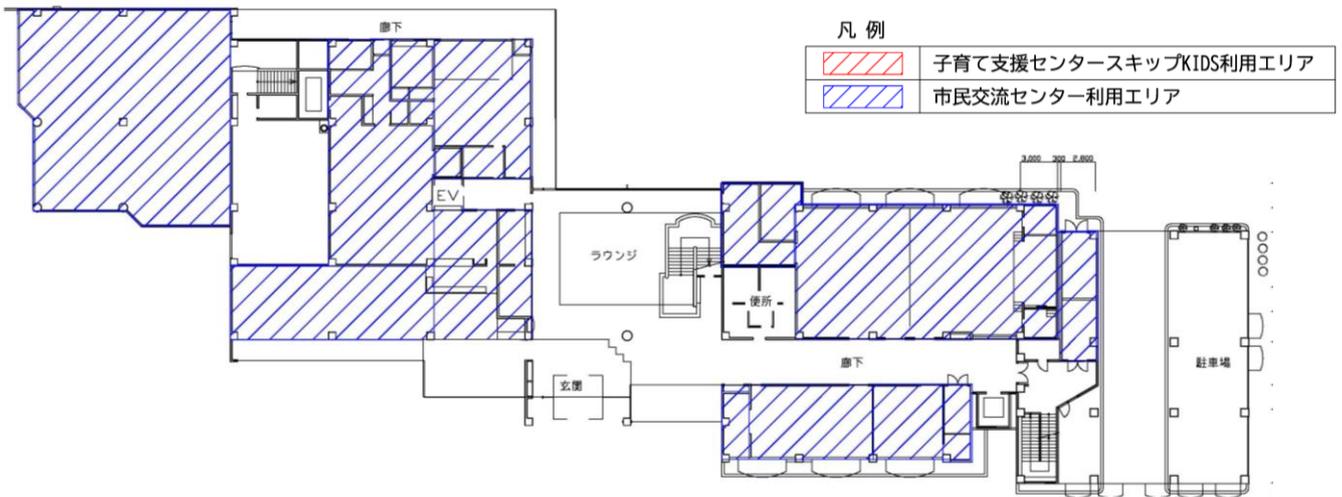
市民交流センター（サンヒル柏原）機能位置図（案）1階平面図
